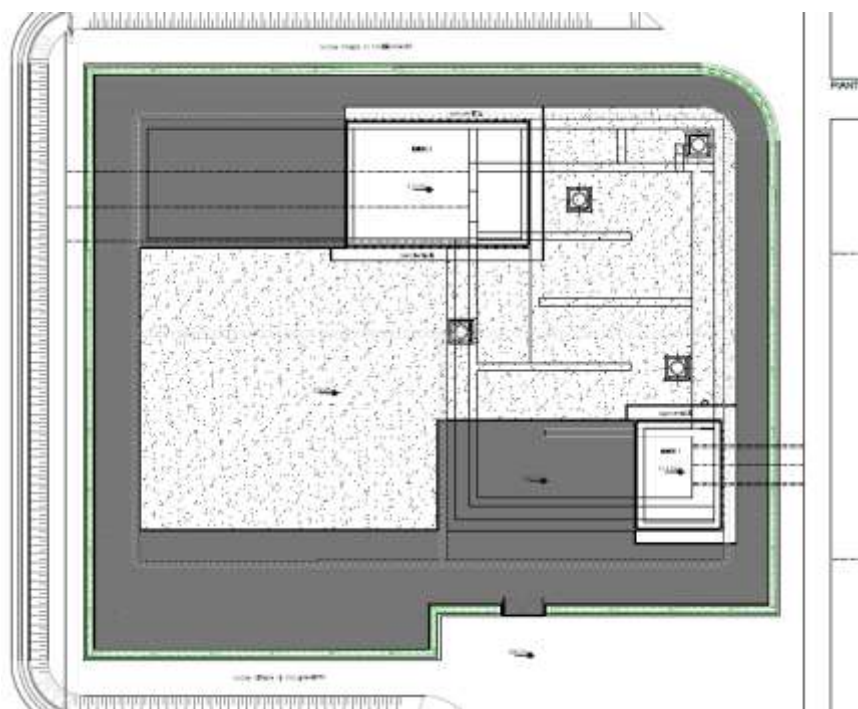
Planimetria piazzale quota +406.40m s.l.m
